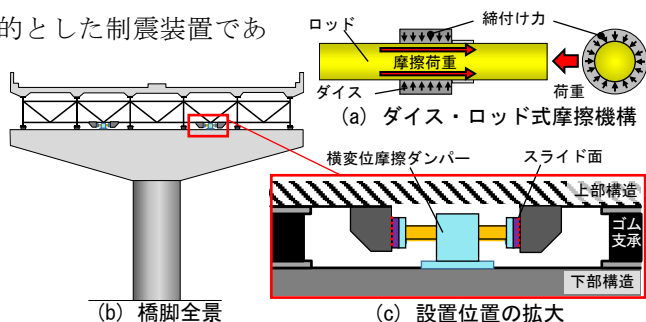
横変位摩擦ダンパー設置イメージ（橋軸直角方向）
